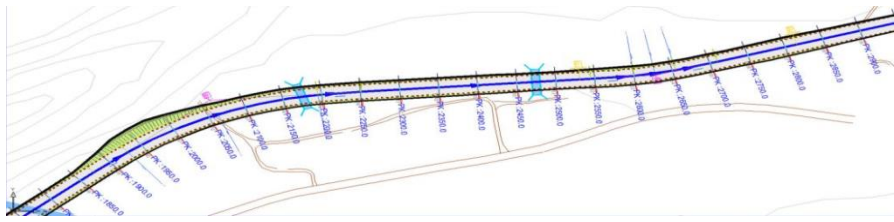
Tracé en plan d'une route [Visa, 2008]
